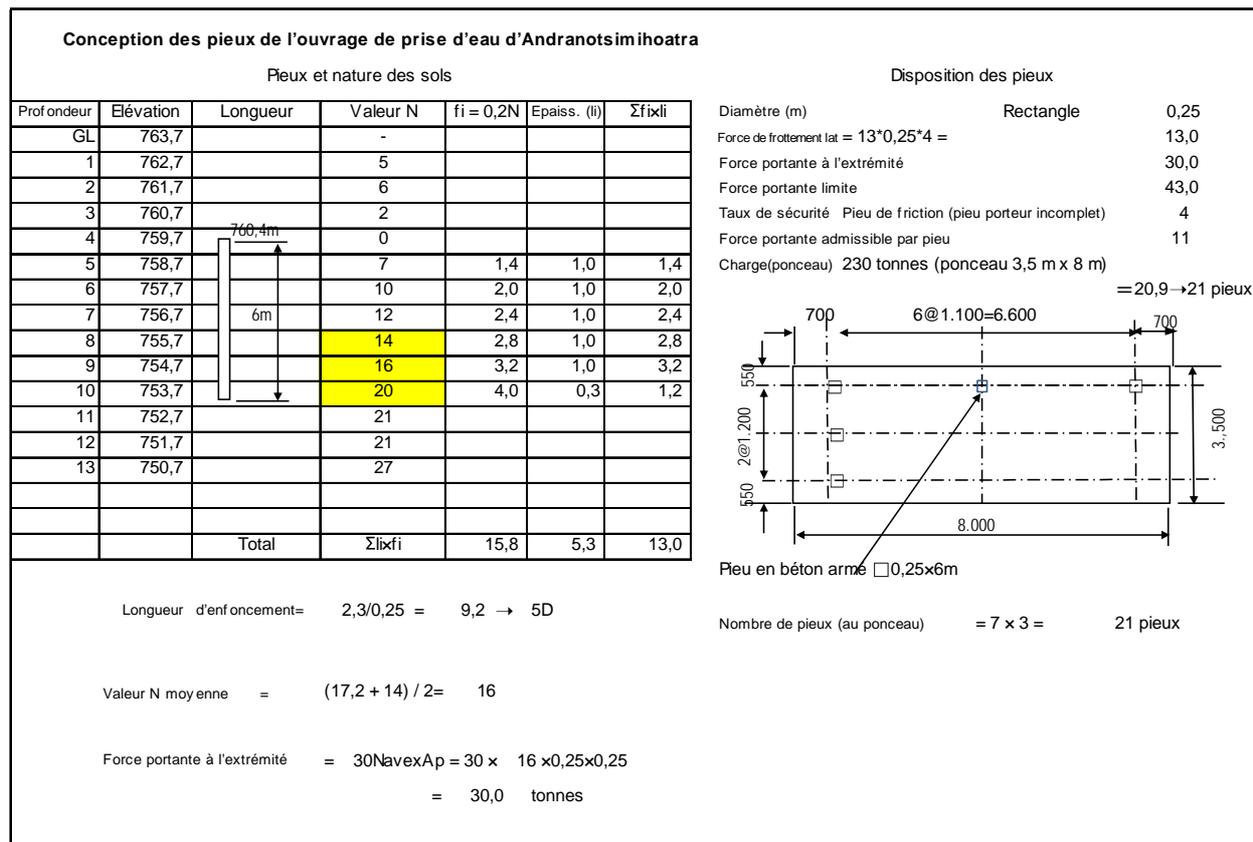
Conception des pieux de fondation de l'ouvrage de prise d'eau d'Andranotsimihotra
